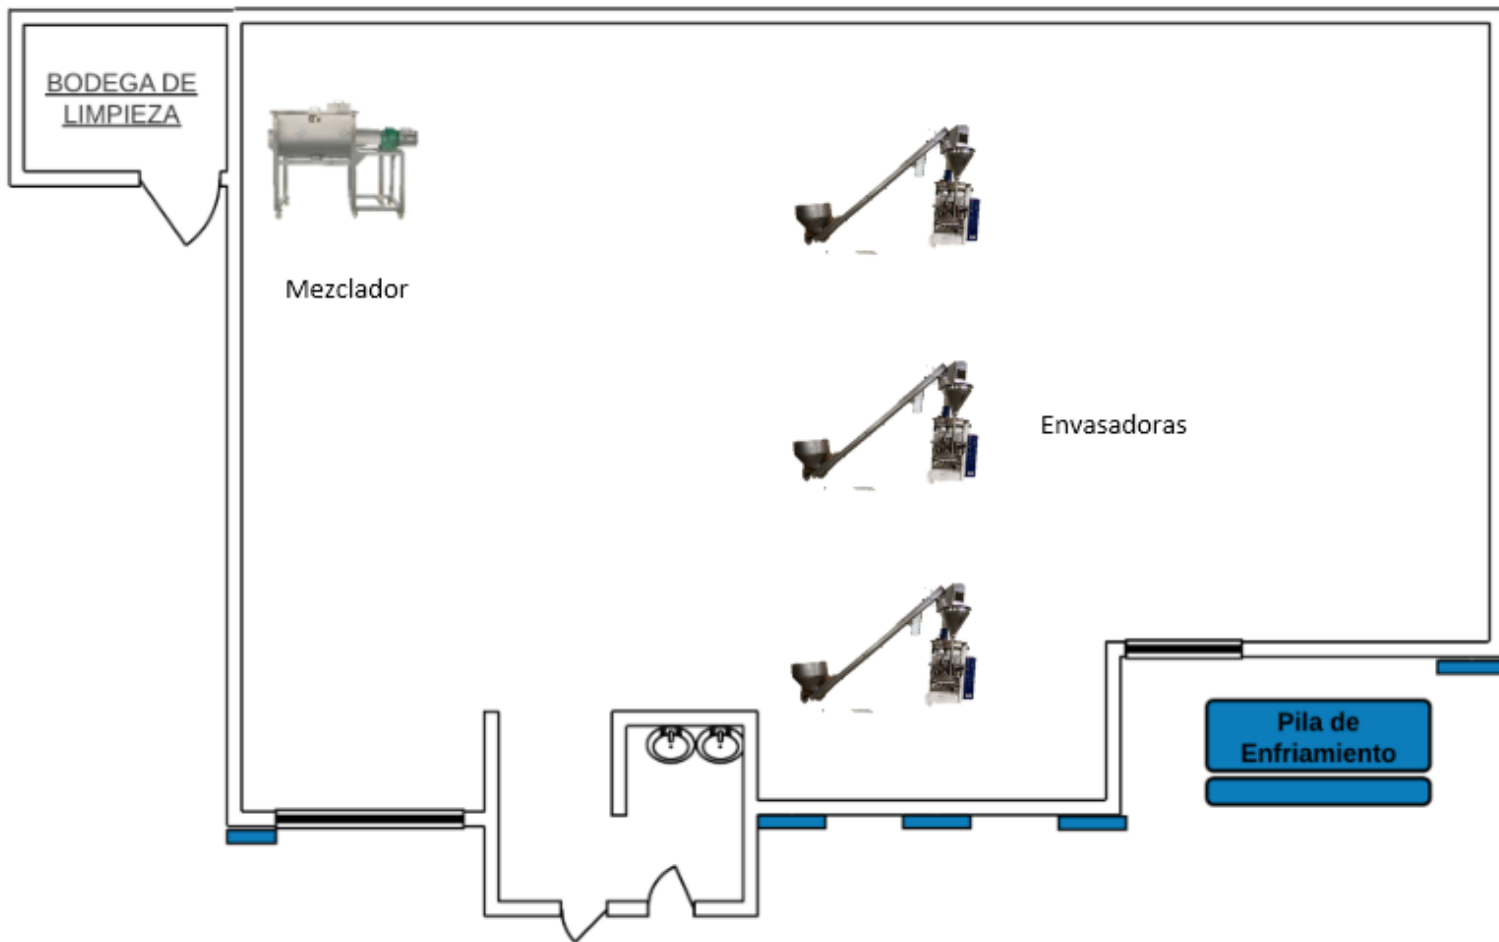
Ilustración de distribución de la Planta Postres y Bebidas
